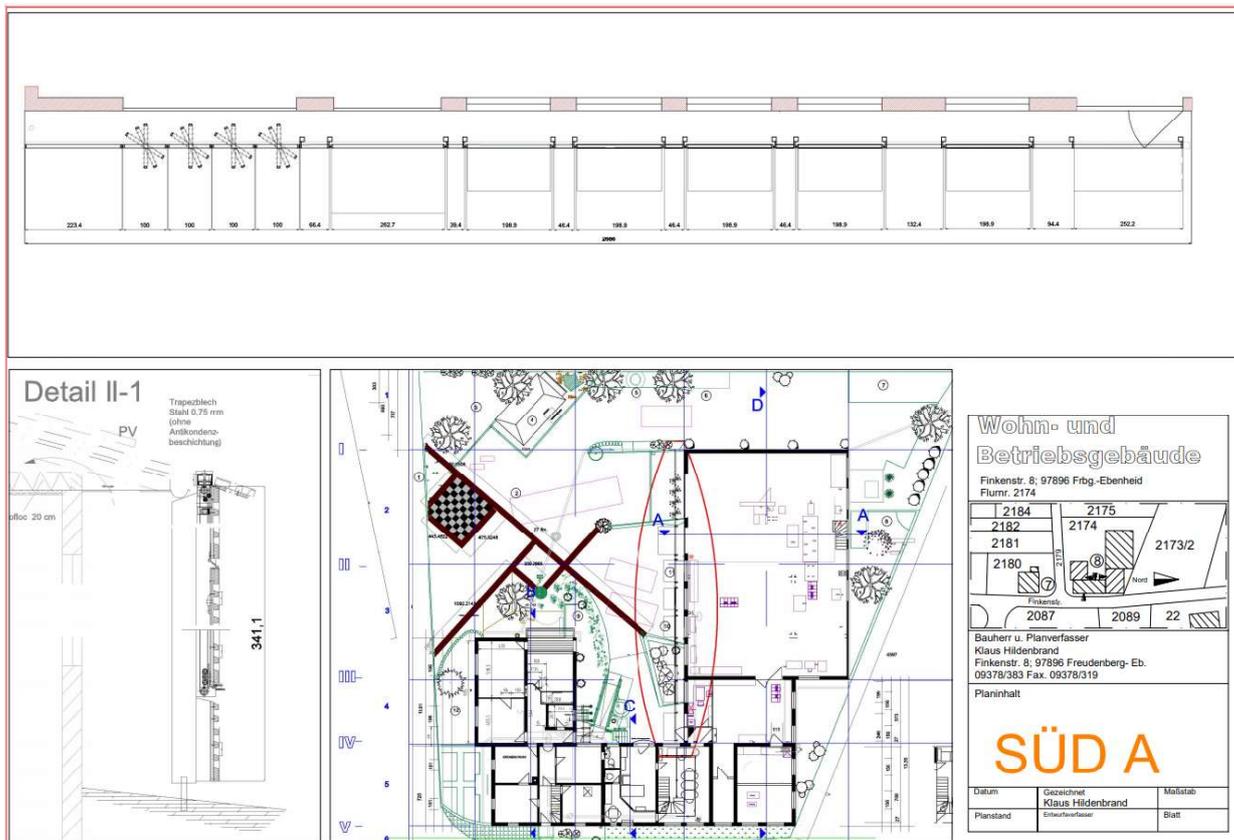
Südansicht und Horizontalschnitt der Testfassade; Werkplan hilbra
